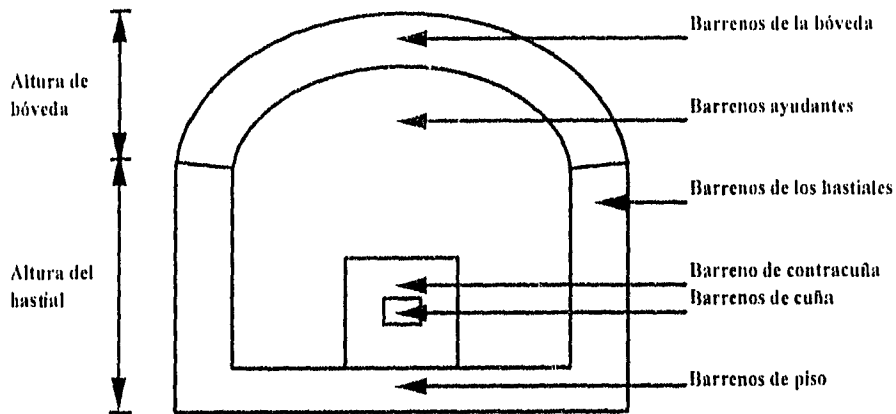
Tipos de barrenos en la sección de un túnel
